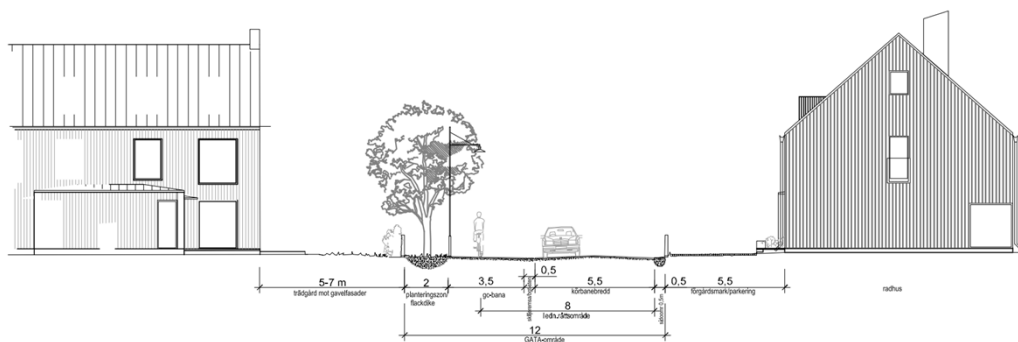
Föreslagen trafikstruktur inom detaljplanerna Bälunge-Ekeby 1:2 och Gysta 1:13. Iterio.
